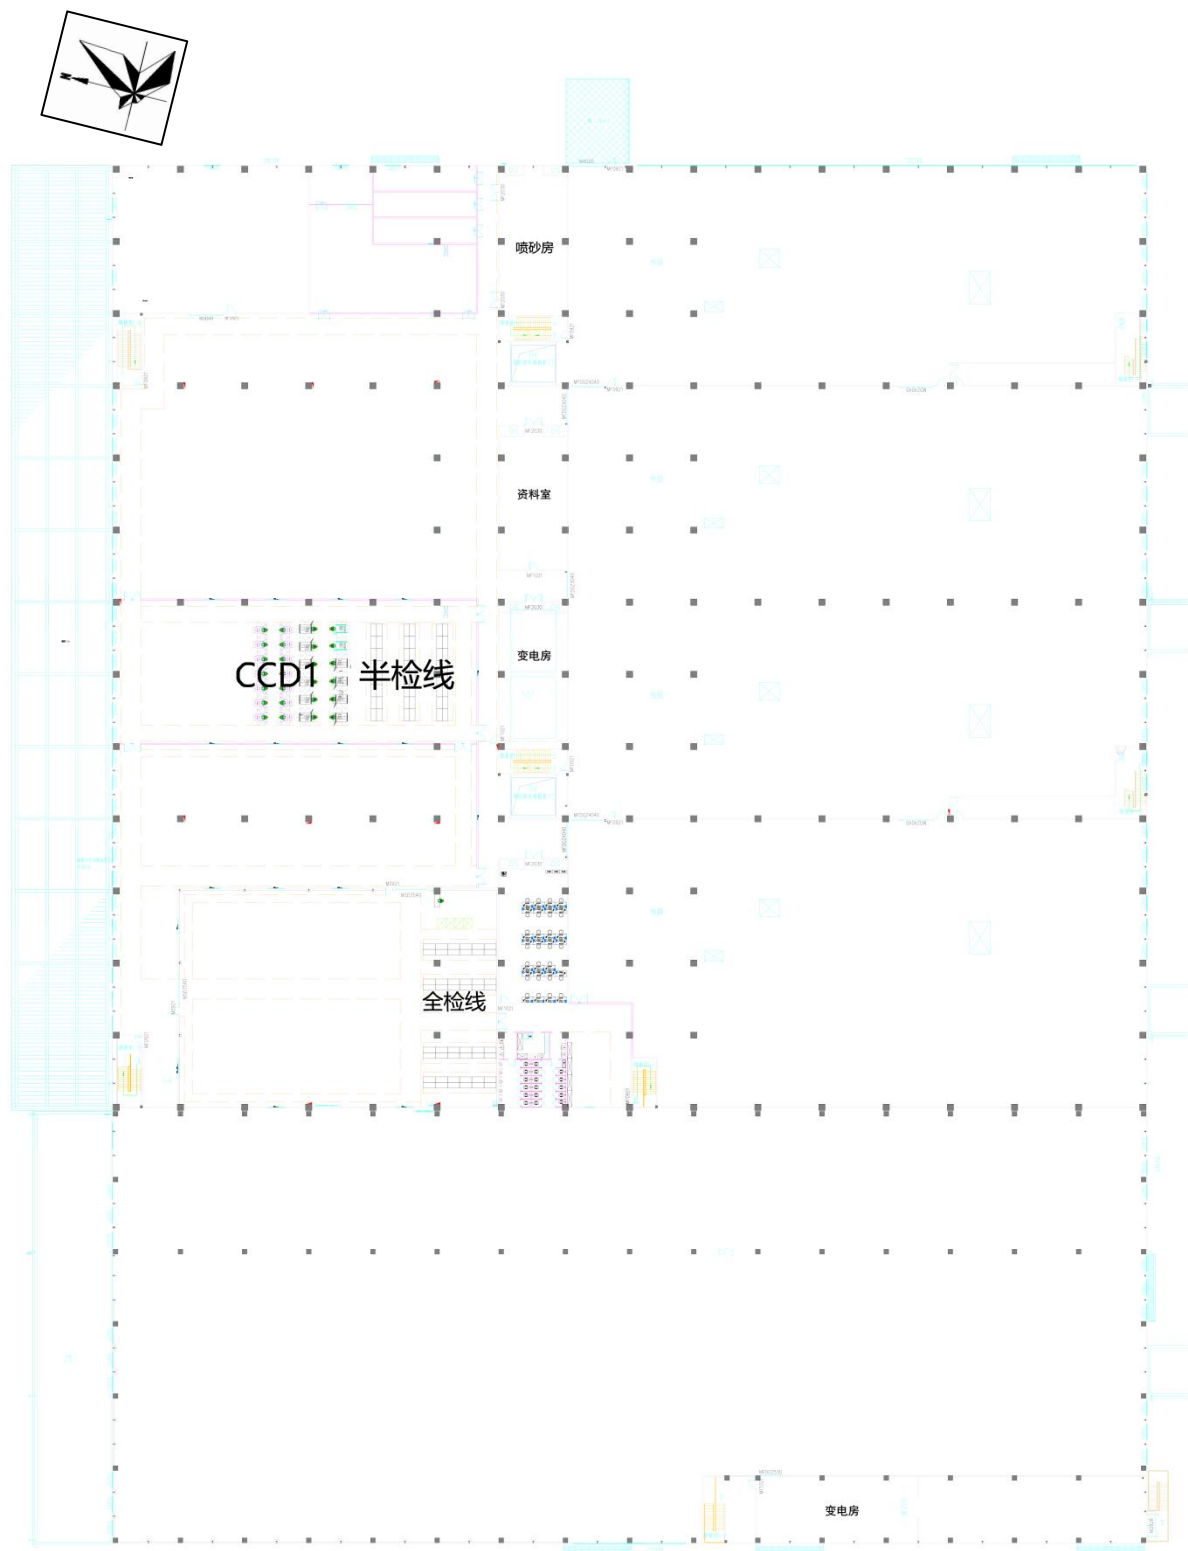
项目平面布置图（厂房 1、厂房 2 二楼）
